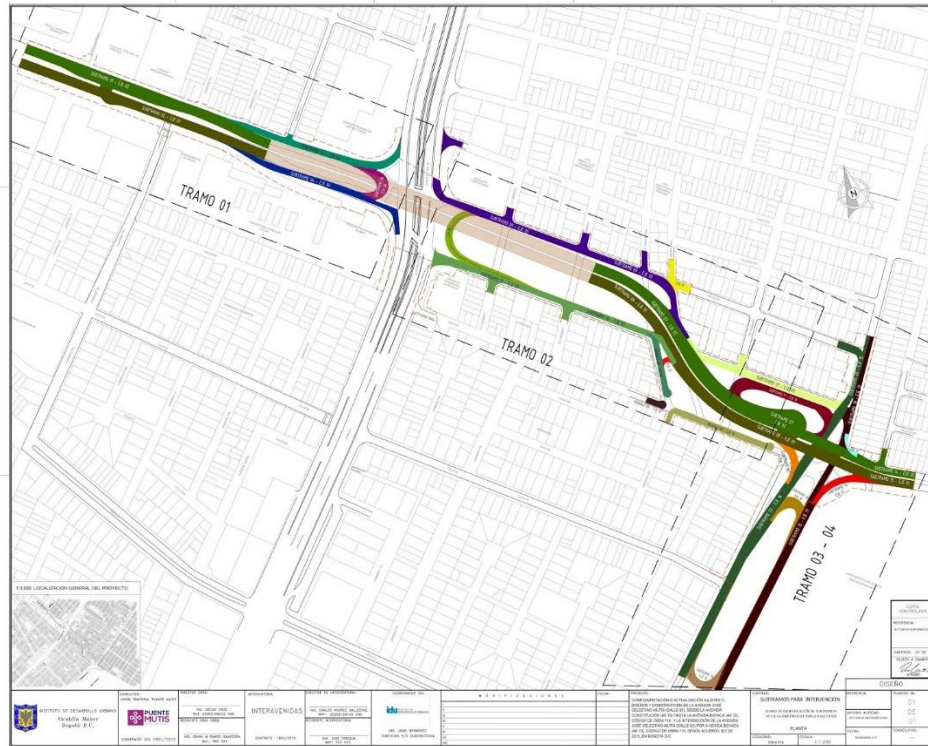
Plano Ejes de Trabajo, Fuente Unión Temporal Puente Mutis
